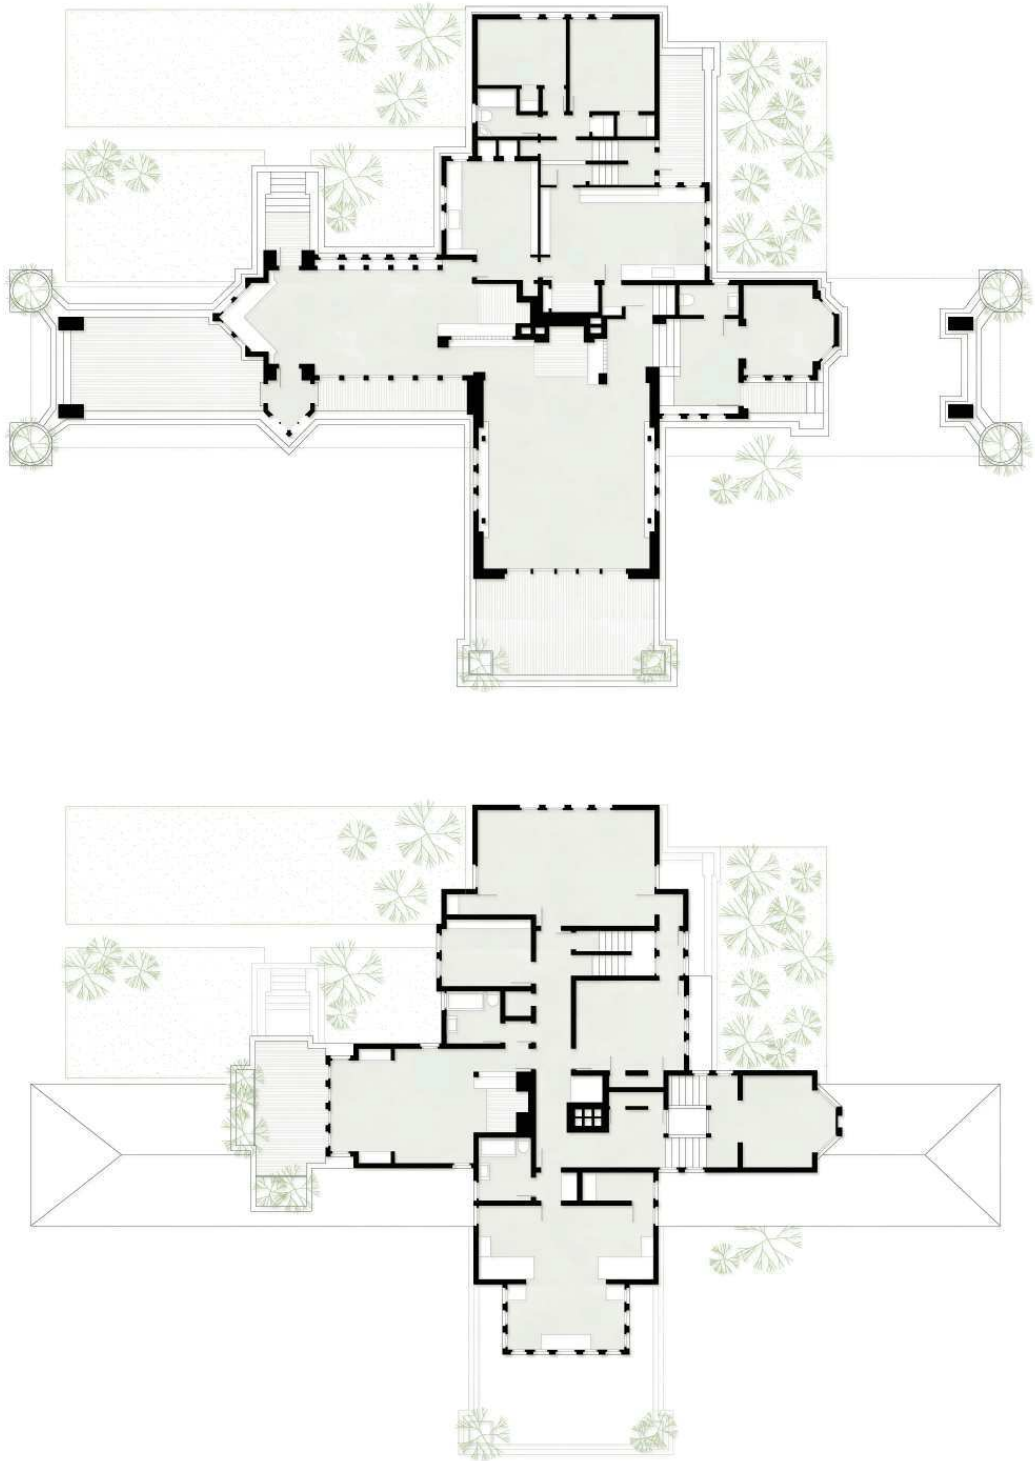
Figura de autor. Planta baja y primera casa Ward Willits.
